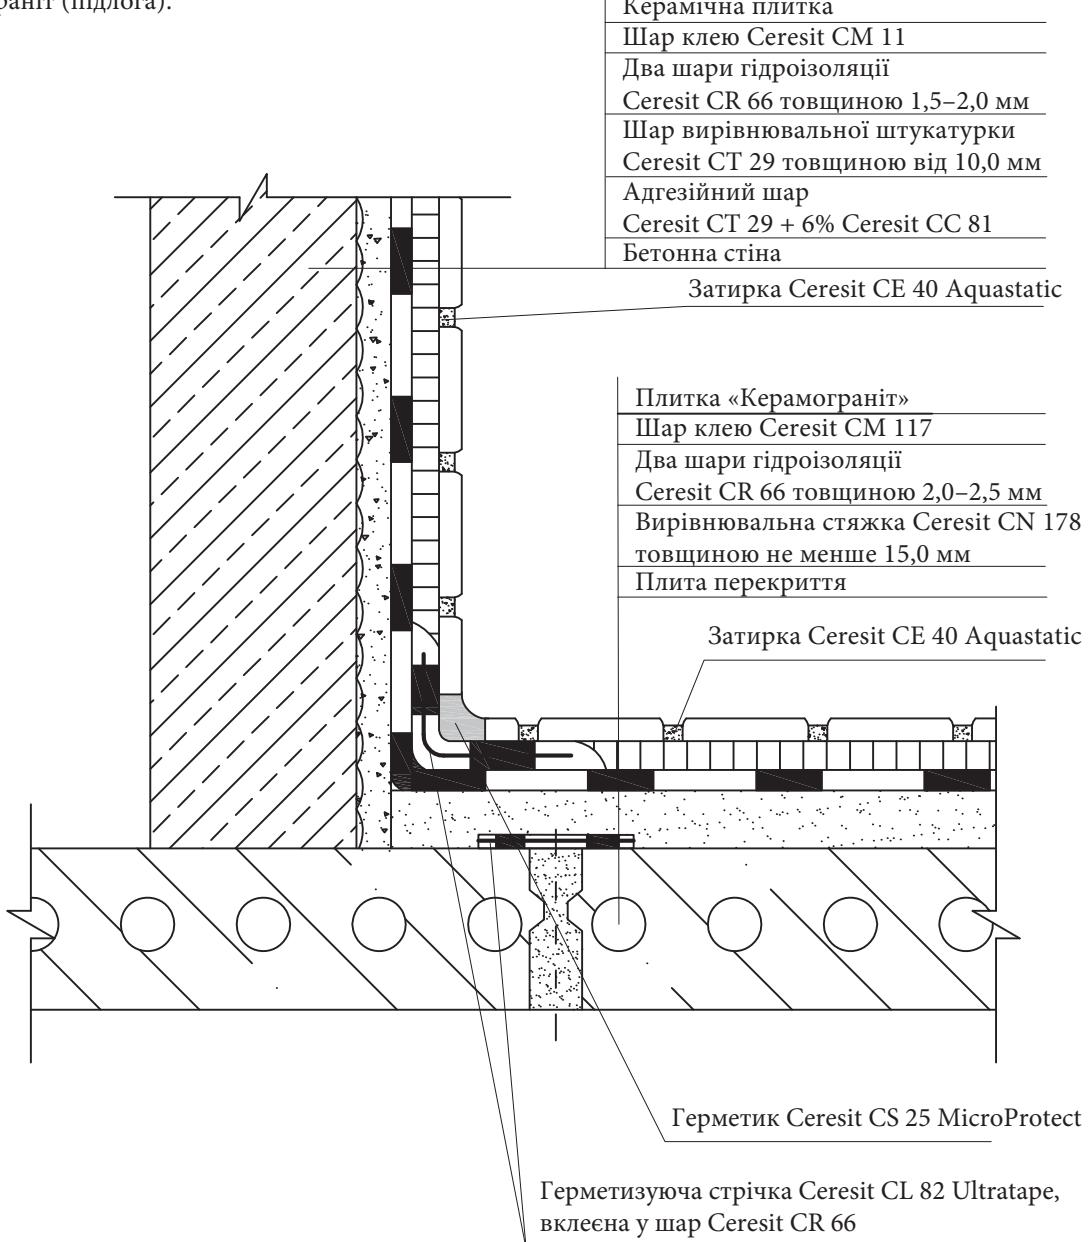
Конструкція системи гідроізоляції для виробничих душових приміщень, розташованих на плитах перекриття
